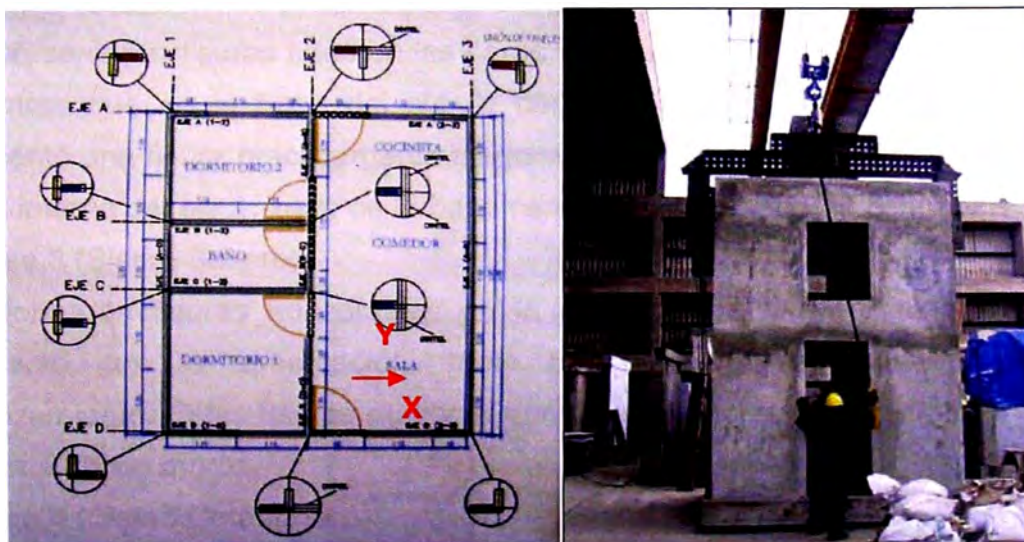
Plano en planta y Módulo para el ensayo sísmico
